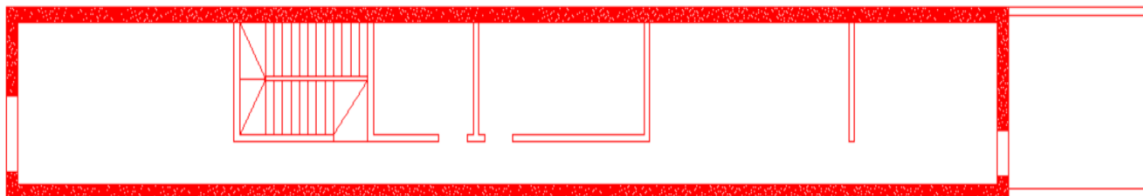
plano de la envolvente de la vivienda modelo. Elaboración propia.
